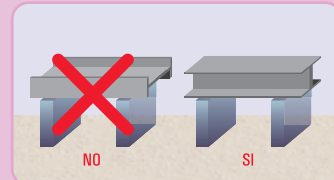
Dos vigas metálicas doble T (una colocada de canto)
